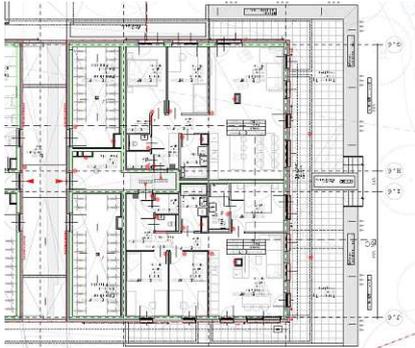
THEOs Bpl.6 PP-Grundriss mit TAG Verortung im EG, S. 406
